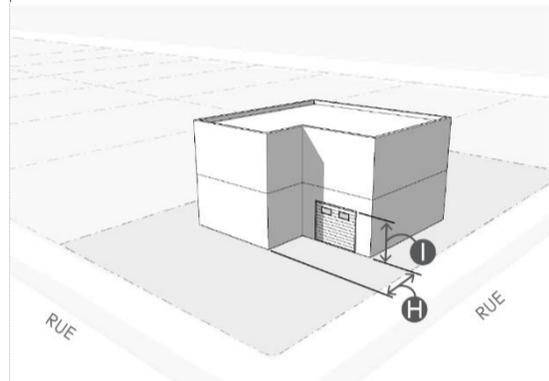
Retrait d'un garage par rapport à un plan de façade principal et hauteur d'une porte de garage
